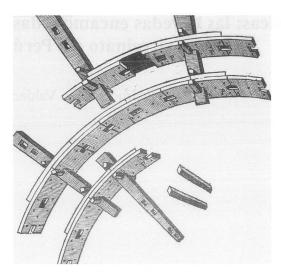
Detalle de las piezas y uniones en la propuesta de De L'Orme para sus bóvedas de madera (De L'Orme 1561)
